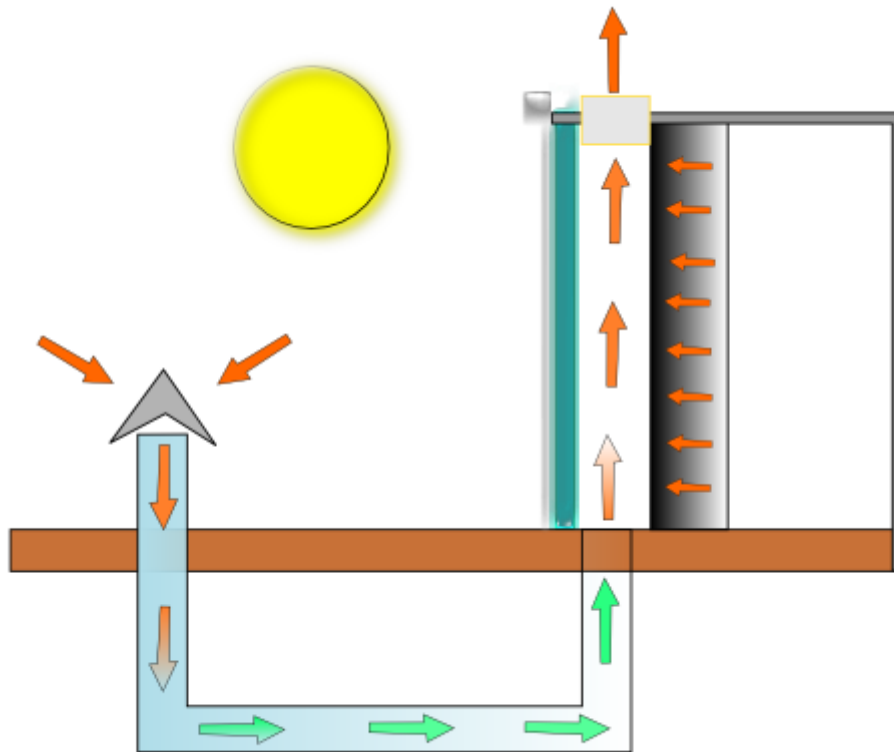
Combinación fachada ventilada y conductos enterrados.
